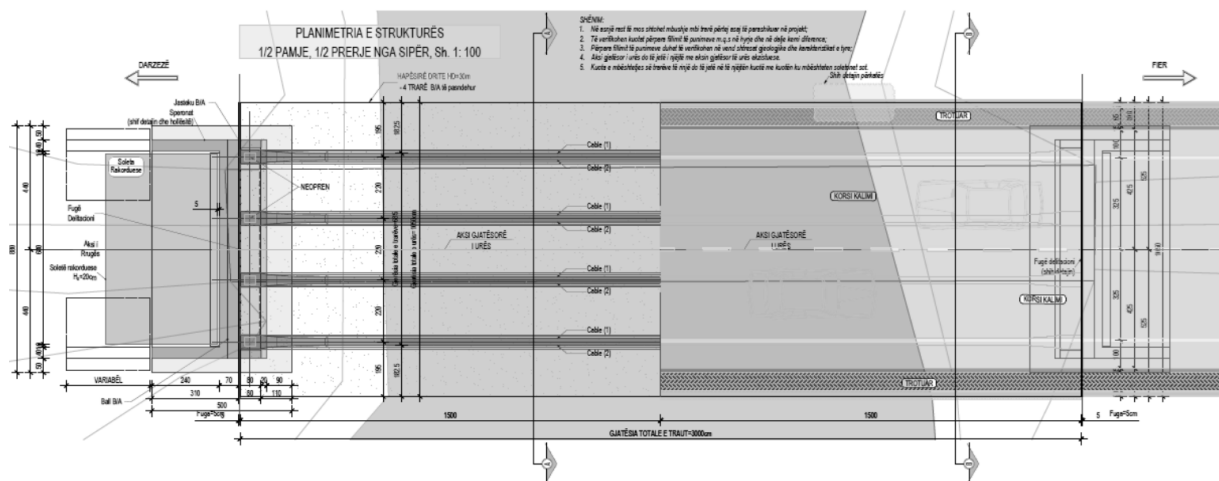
Planimetria (gjysmë pamje-gjysmë prerje)
